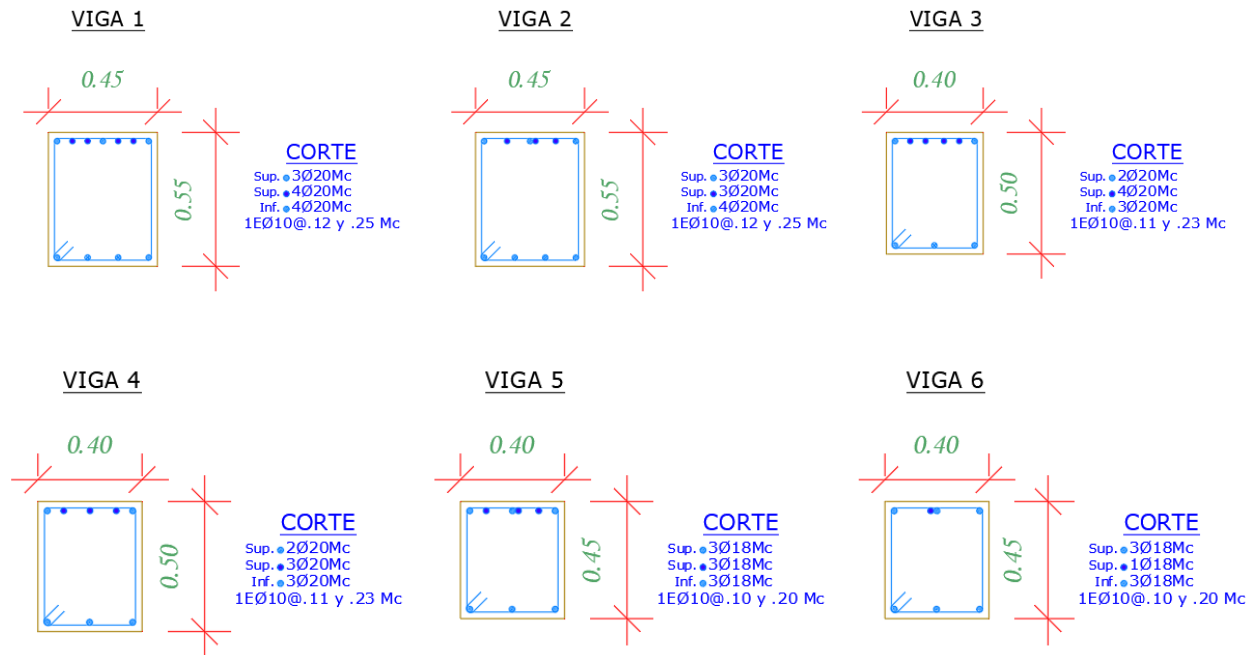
Secciones transversales de las vigas utilizadas en un edificio de 6 pisos
